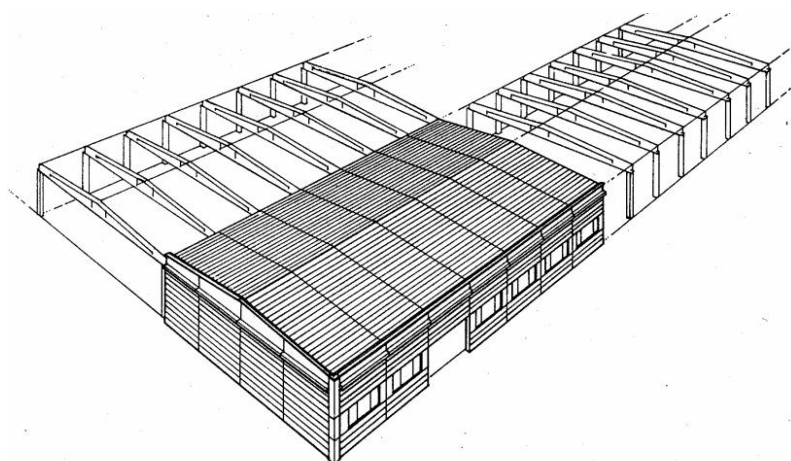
Exemplo de estrutura em pórticos pré-fabricada [11]
